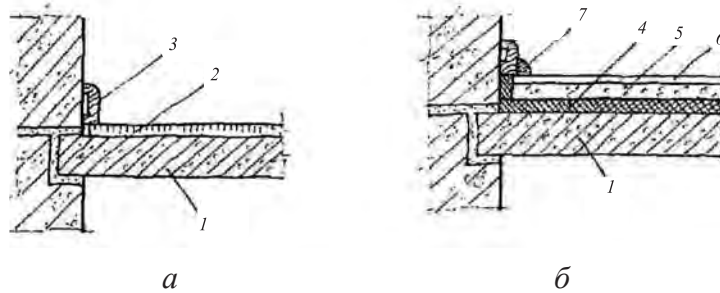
Полы из линолеума: *а* — на упругой основе; *б* — без упругой основы: 1 — плита перекрытия; 2 — линолеум на упругой прокладке; 3 — плинтус; 4 — звукоизоляция; 5 — стяжка; 6 — линолеум; 7 — раскладка
